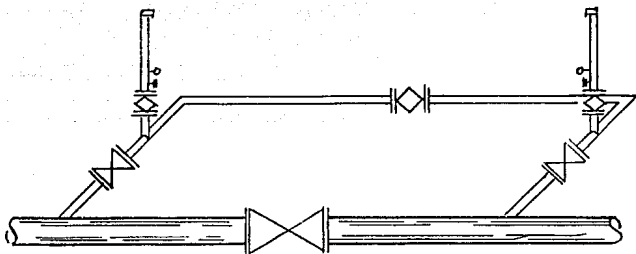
Válvula de seccionamiento con su By - Pass.
